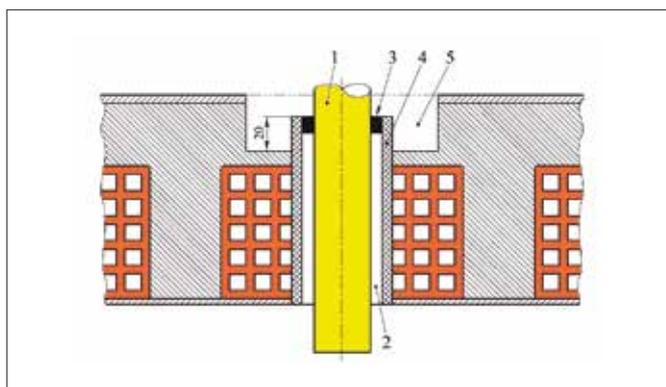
Attraversamento di solette (pavimento o soffitti)
